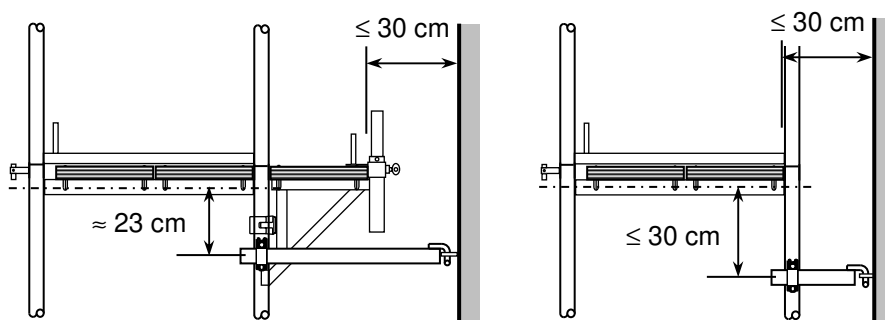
Höhenlage der Gerüsthalter bei versetztem Anschluss
